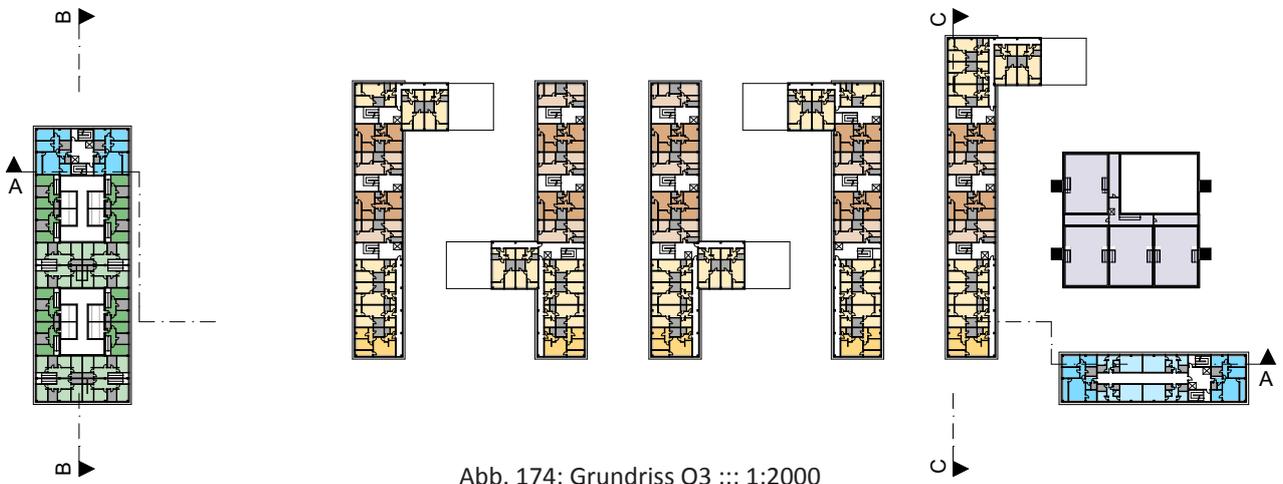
Grundriss O3 ::: 1:2000
